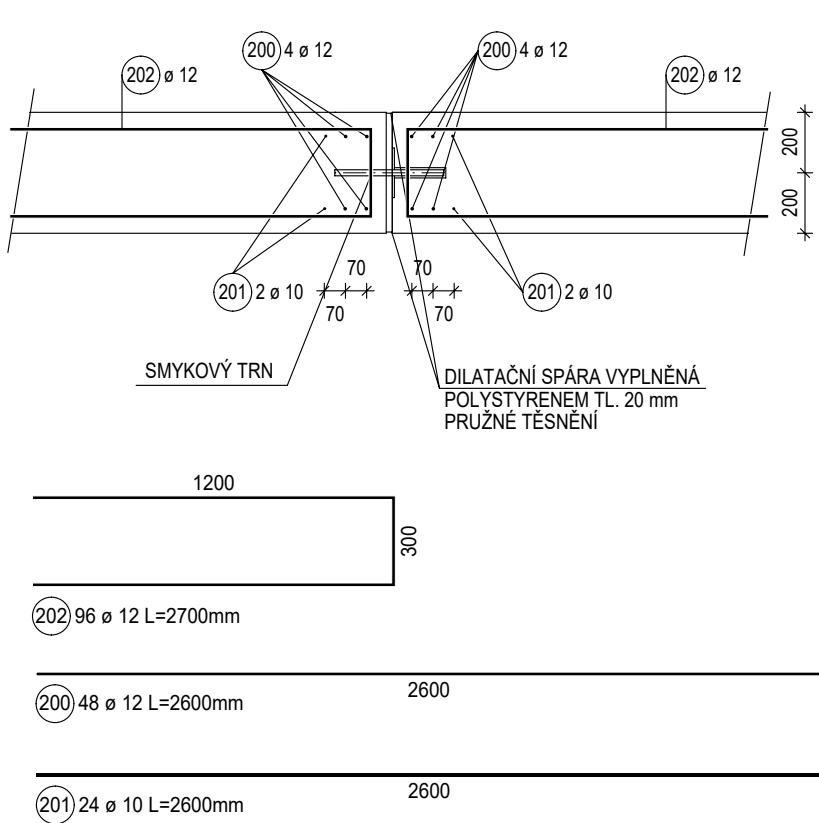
DETAIL PŘIVÝZTUŽENÍ OKOLO SMYKOVÝCH TRNŮ
